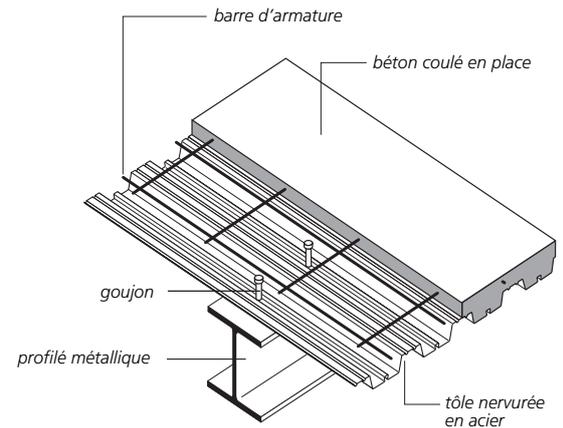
Exemple de plancher à tôle profilée collaborante
